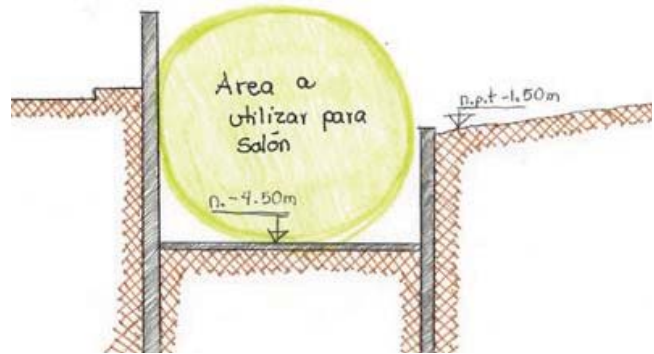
Corte esquemático de terreno 1 donde se propondrá utilizar para salón de usos múltiples
